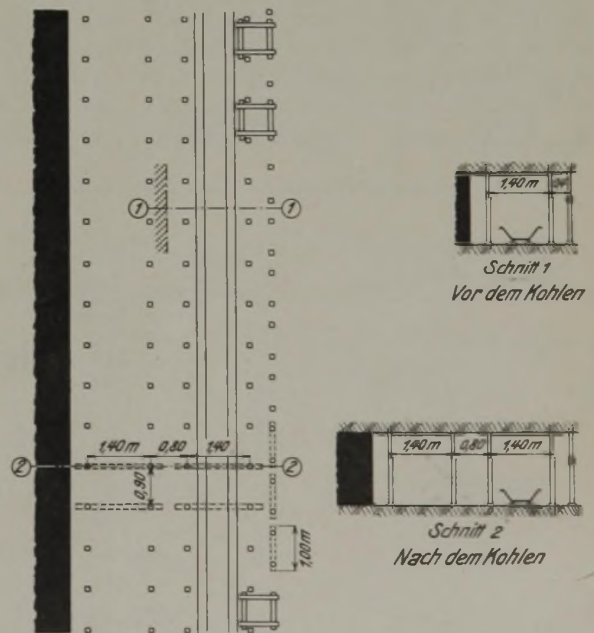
Stribbruchbau mit Eisenkasten und Reihenstempeln.
